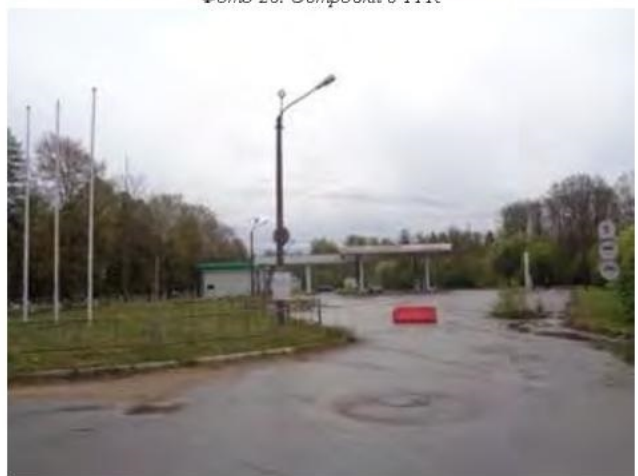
Ограждение и асфальтобетонное покрытие АЗС
